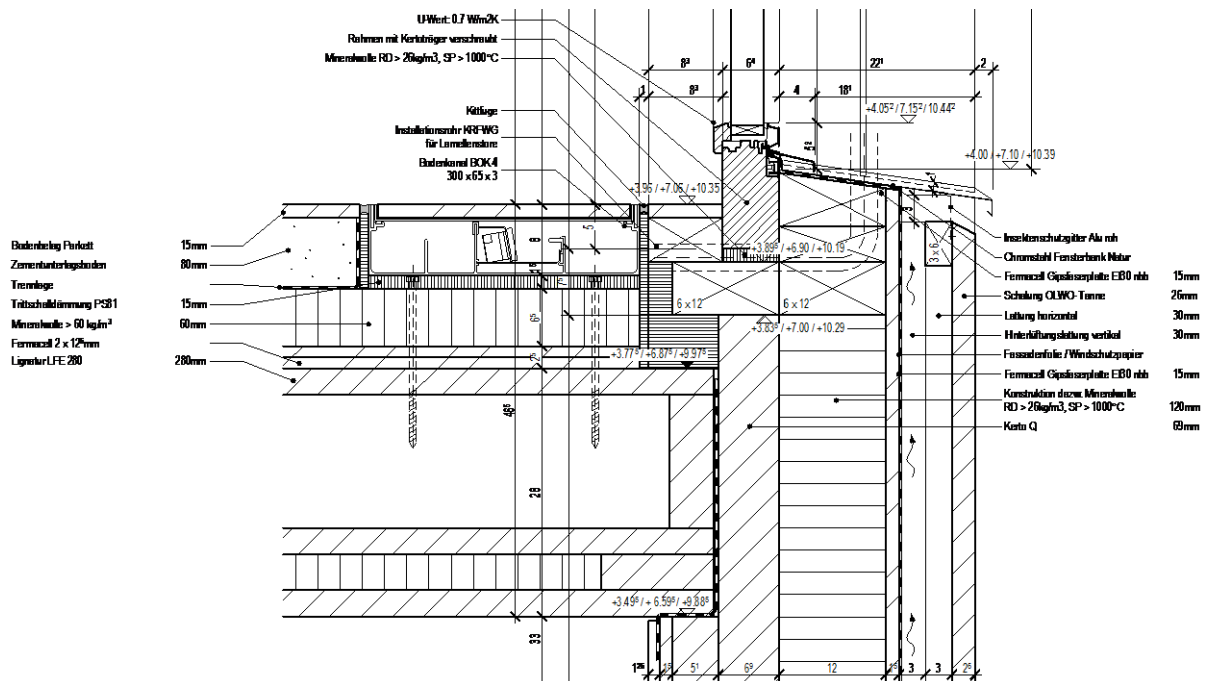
Detail des Anschlusses Decke-Fassade mit dem Kabelkanal, nicht maßstäblich.
